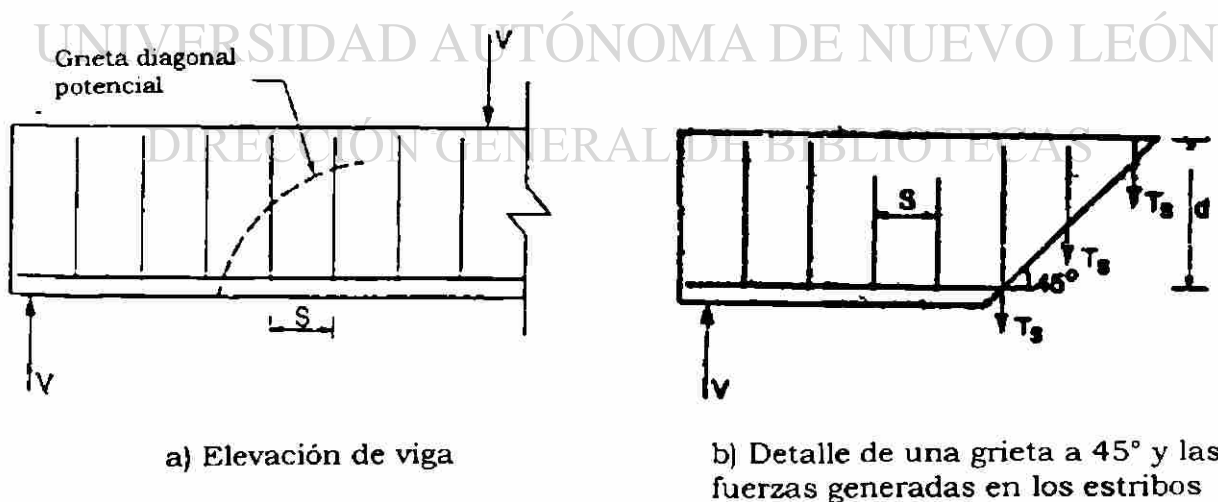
Resistencia para cortante, mediante refuerzo en el alma, en vigas de mampostería reforzadas.
